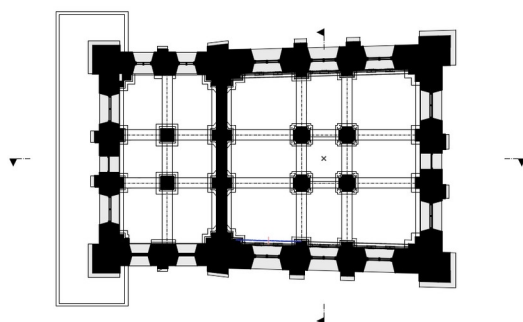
Grundriss_OG_Rekonstruktion
